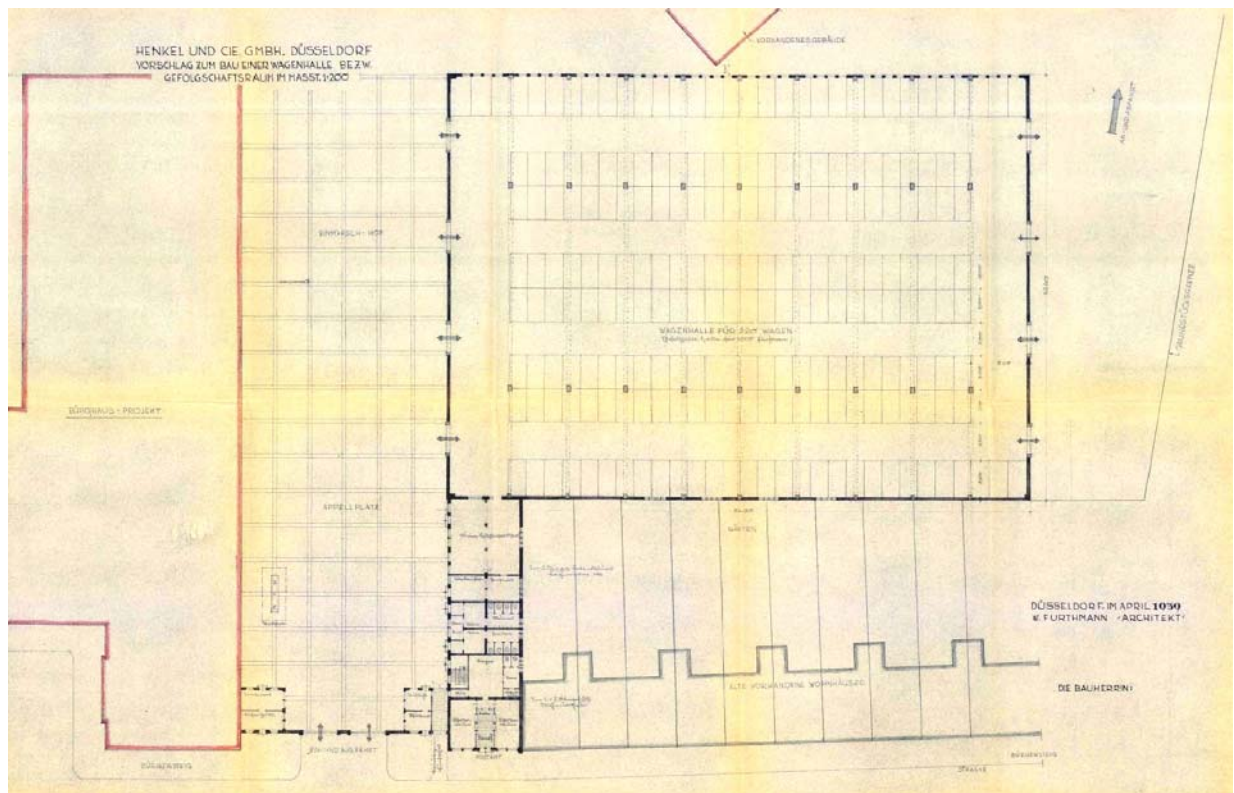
Bau einer Wagenhalle bzw. Gefolgschaftsraum, Grundrisszeichnung vom April 1939 – Architekt: Walter Furthmann
